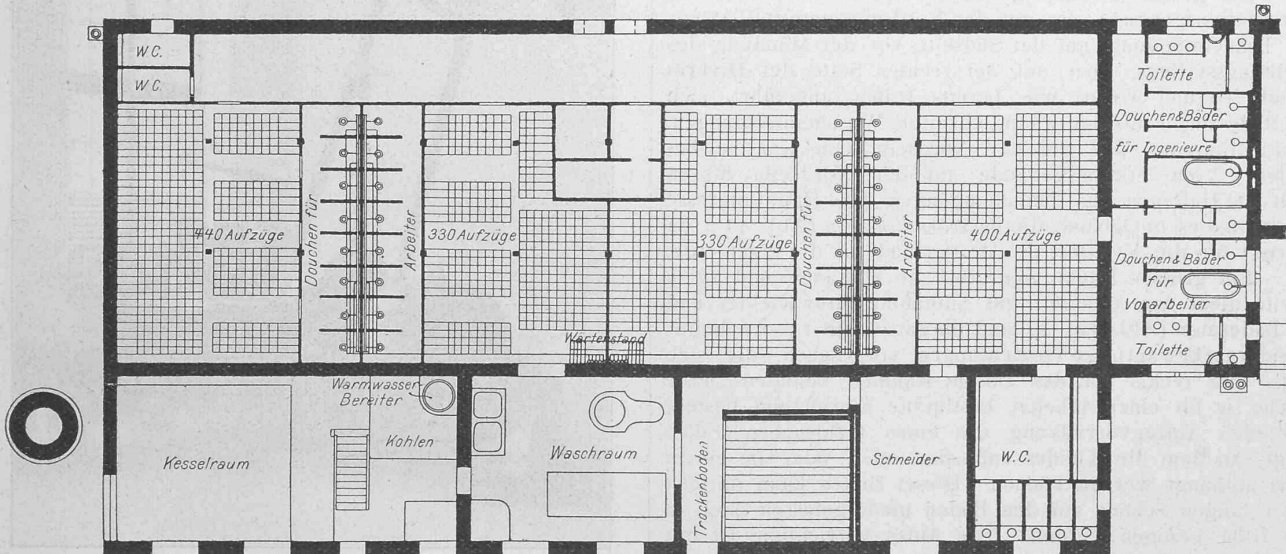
Stationsgebäude auf der Nordseite. — Grundriss der Baderäumlichkeiten und der Wascherei. — Masstab 1 : 250.
